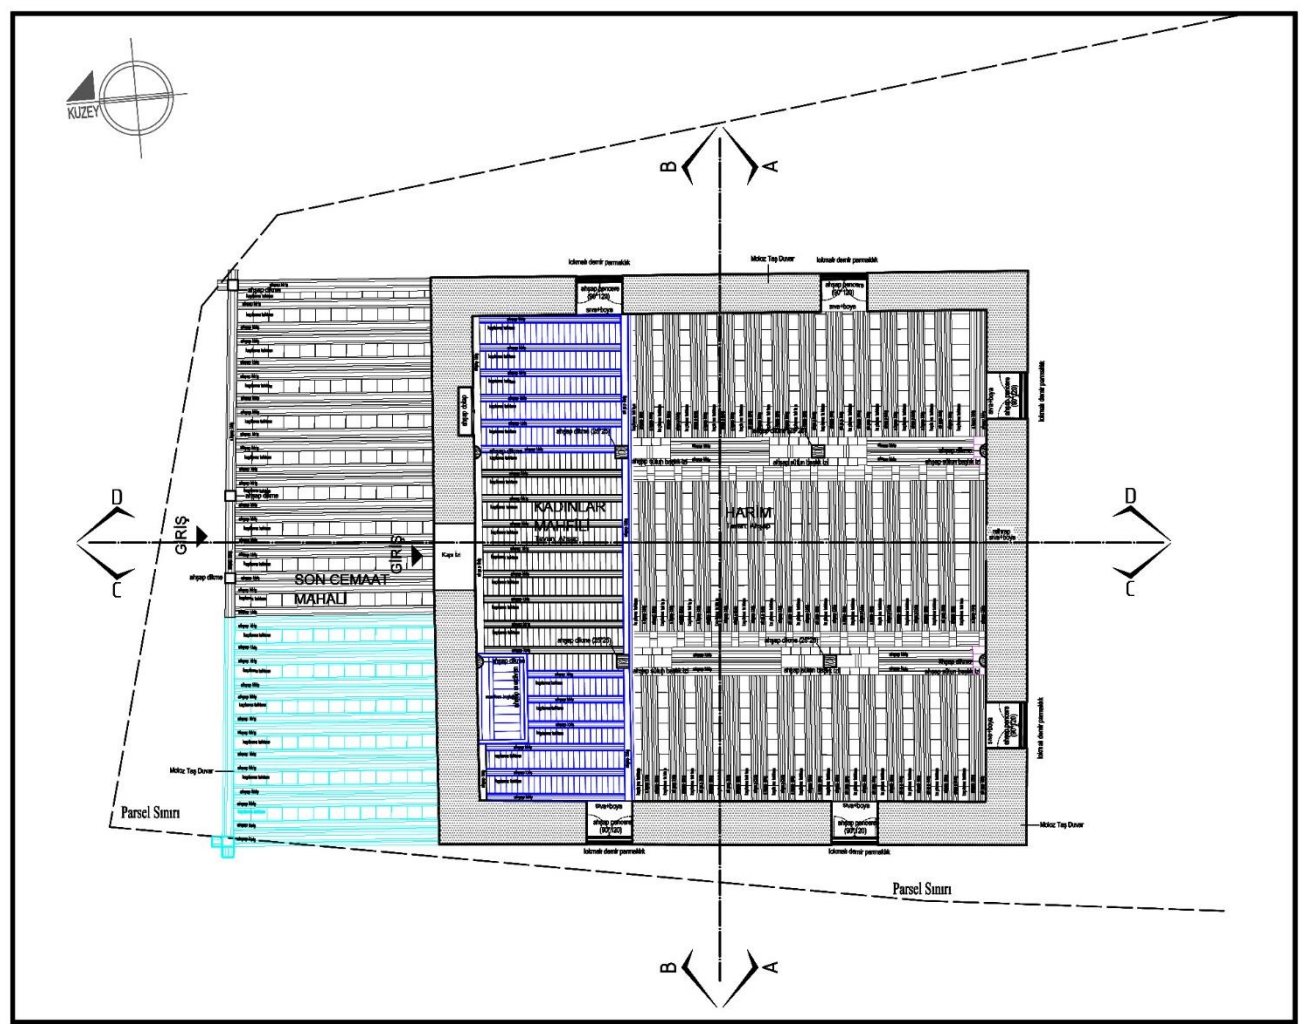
Beklimçay Camii 1. dönem restitüsyon çizimleri: harim kat planı
